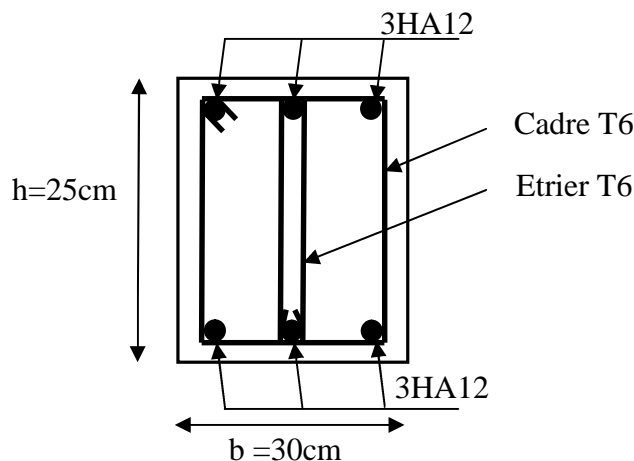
Schéma de ferrailage de la poutre de chaînage
